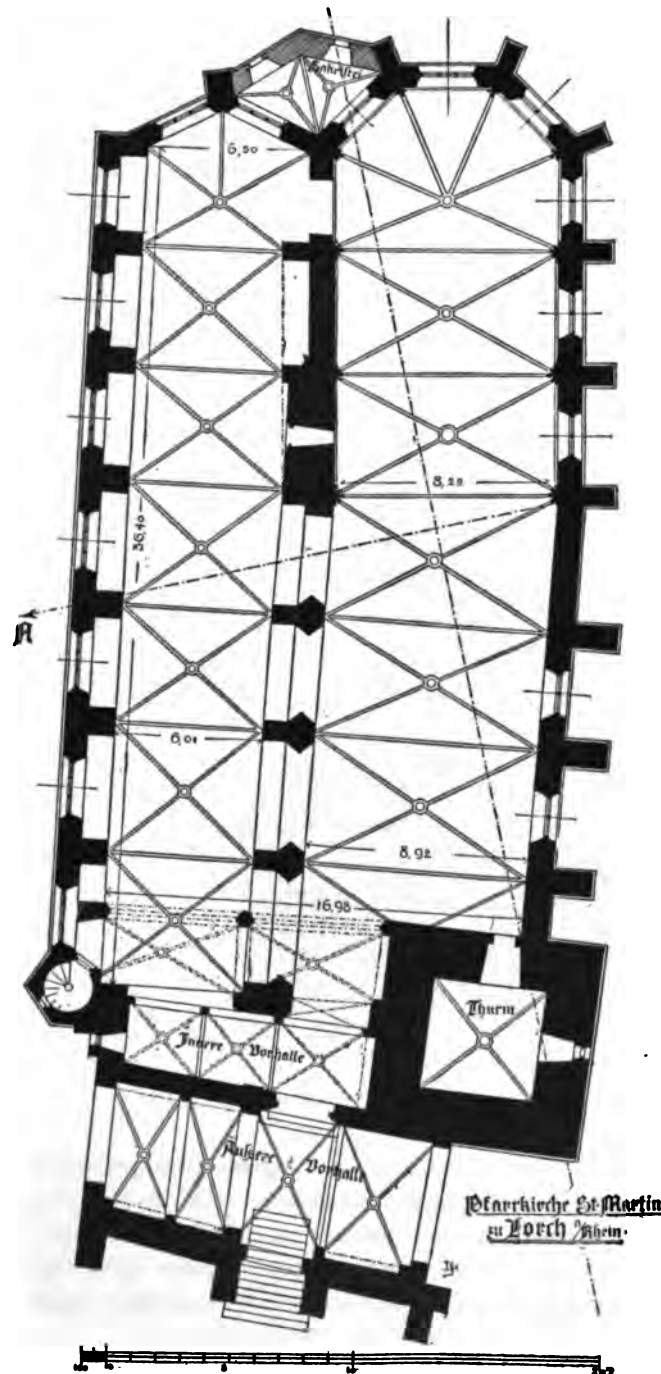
Lorch. Grundriss der Pfarrkirche St. Martin.*)
